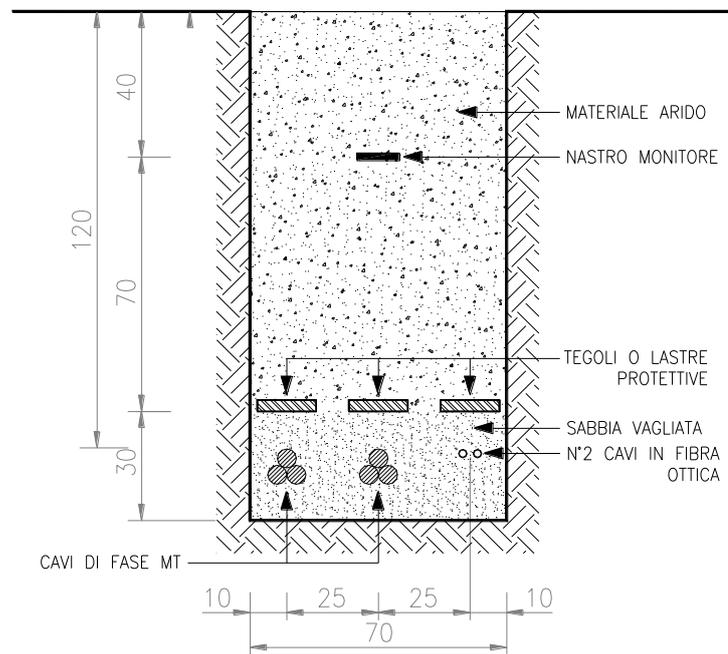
Sezione tipo posa cavo MT con n° 2 linee
